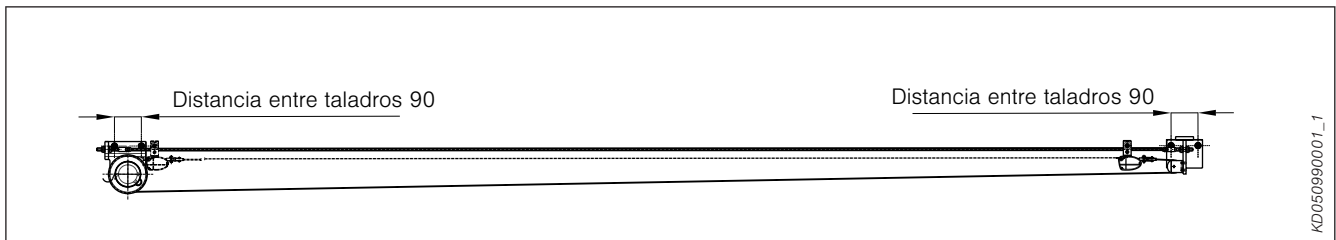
Toldo horizontal, enrollado – con guía de cable
